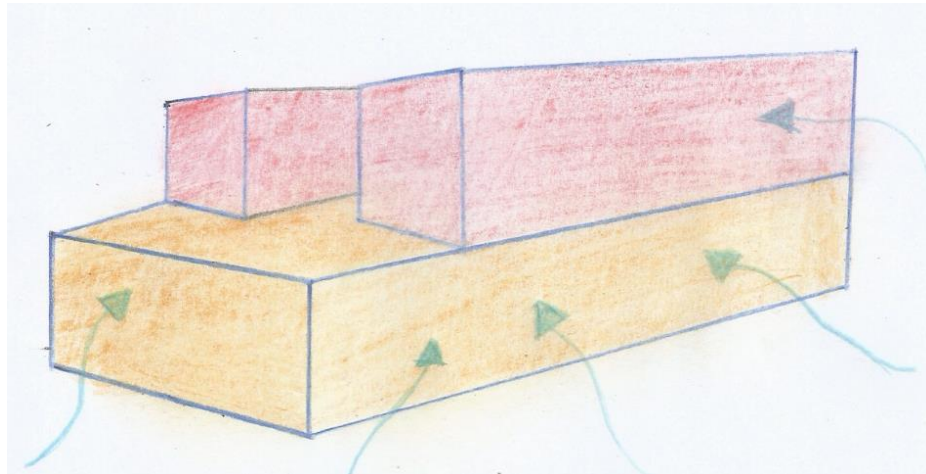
Area Diberikan Shading, Balkon, dan Roof Garden
